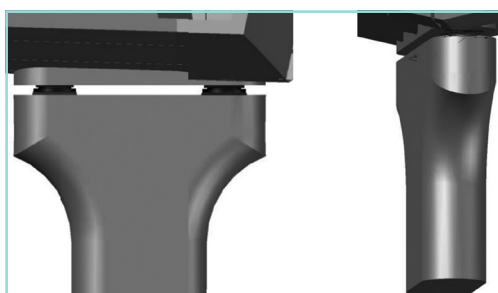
B - MODELO TRIDIMENSIONAL DO PILAR AP4
